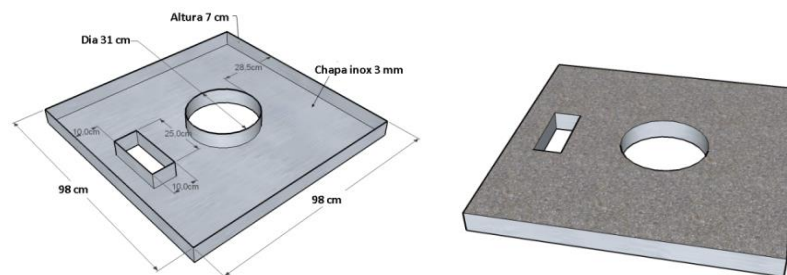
Forma e laje concretada para separar a câmara do pré-aquecedor.
